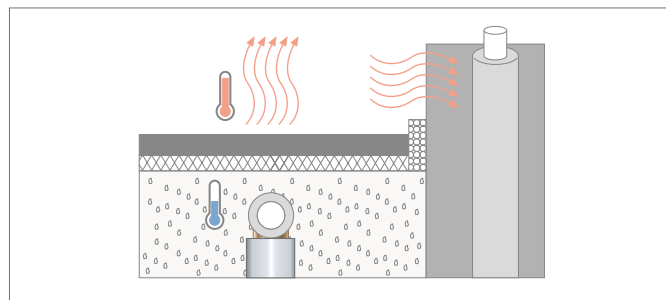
Прокладка под горячим асфальтобетонным покрытием
